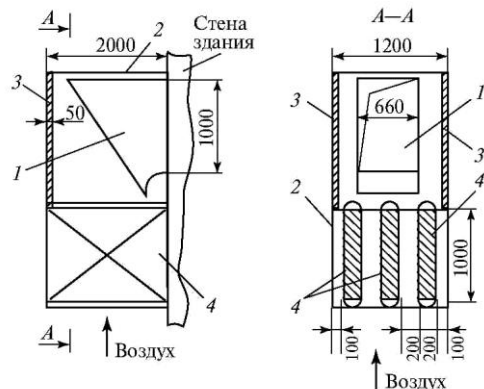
Схема конструкции глушителя шума одинарных воздушозаборов дутьевых вентиляторов ВДН-11,2:
